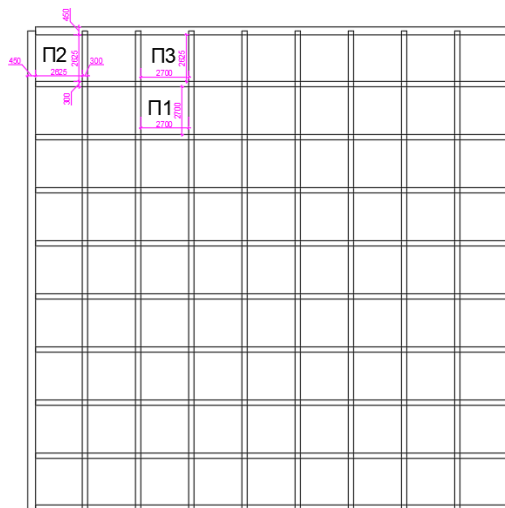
Вид монолитного кессонного перекрытия в плане
